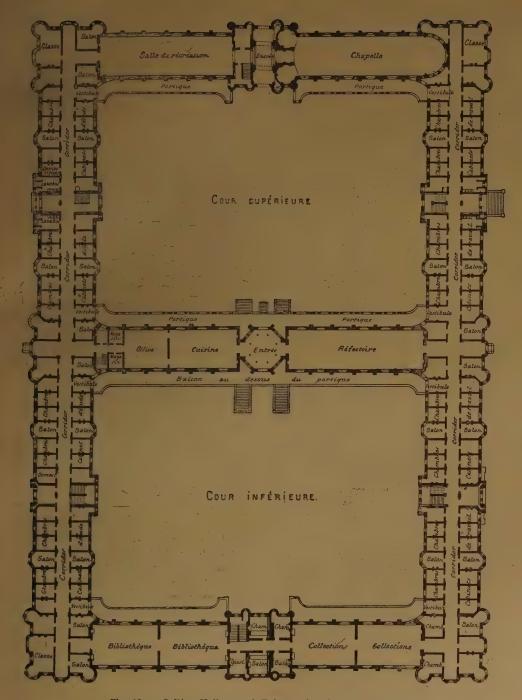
Collège Holloway, à Egham, plan du rez-de-chaussée.
